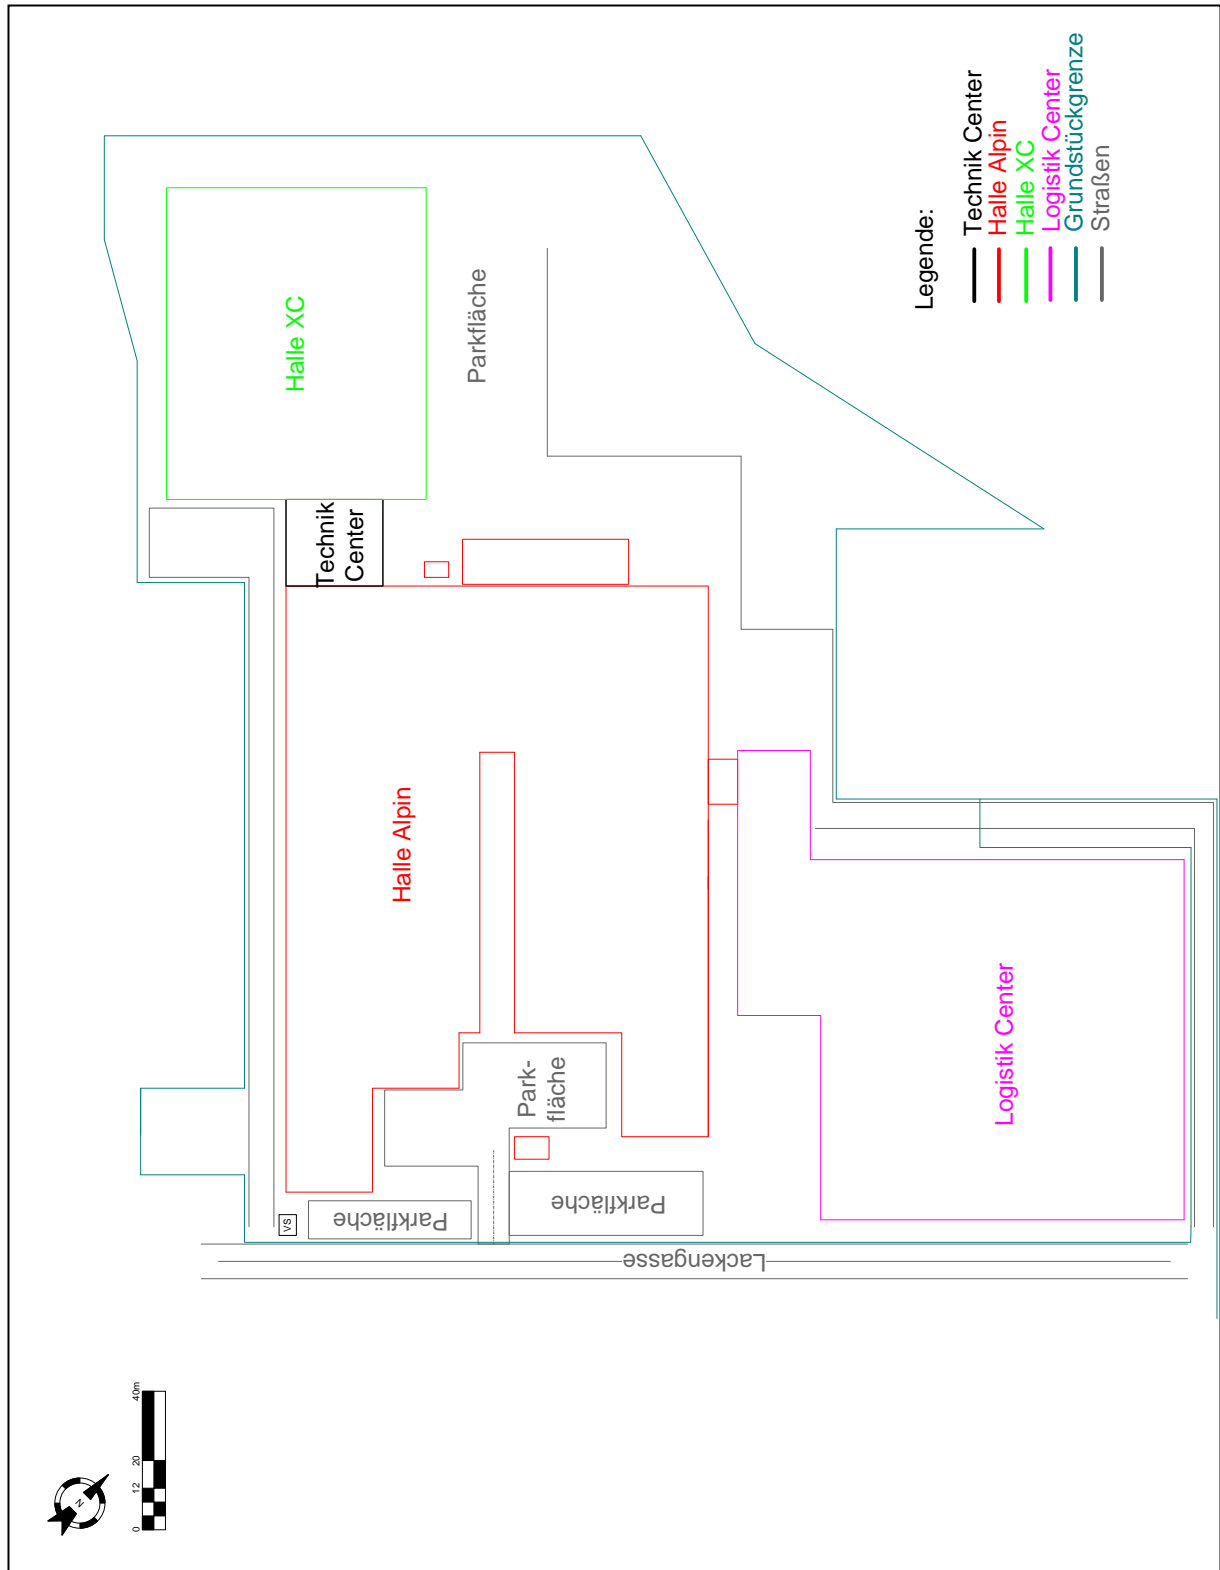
Grundriss Werk Altenmarkt
